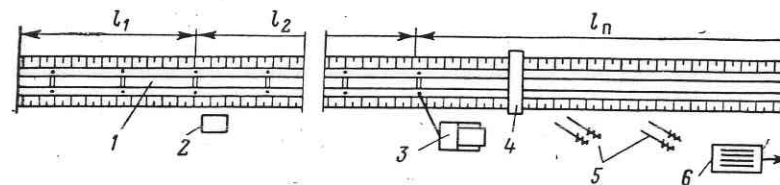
Технологическая схема закрепления трубопровода анкерами
